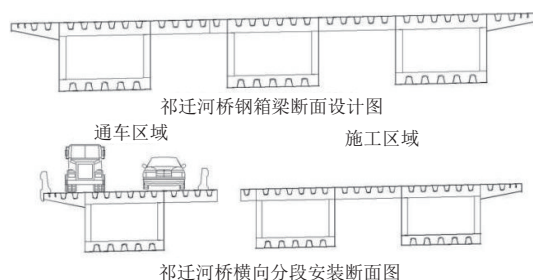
新建祁迁河桥总体布置横断面图和分段施工断面图
